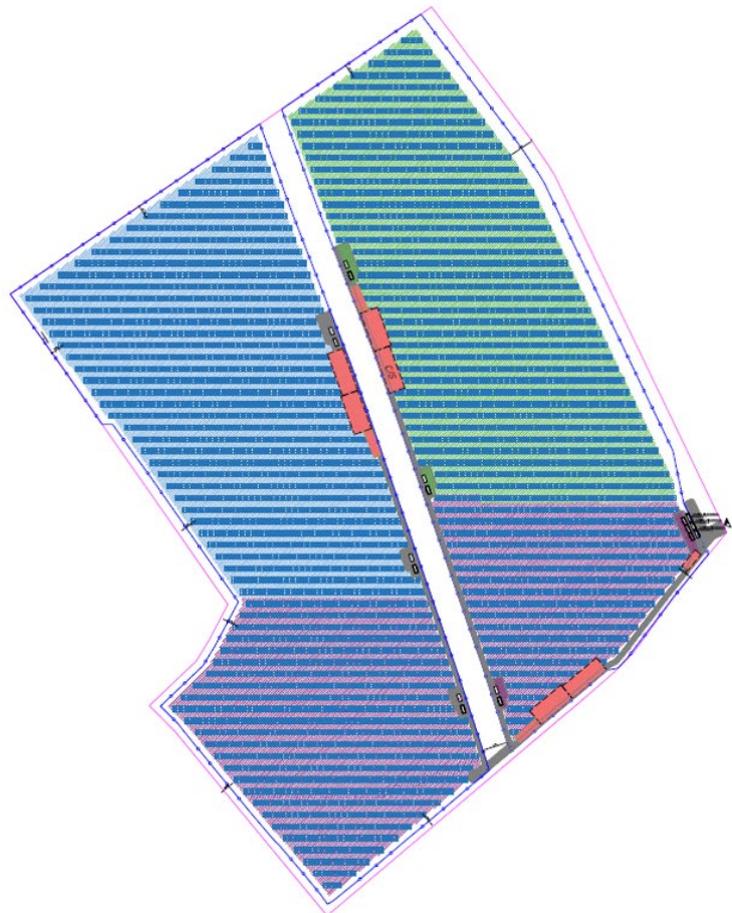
Aree di cantiere "Chions 1" – "Chions 2" – "Chions 3"
